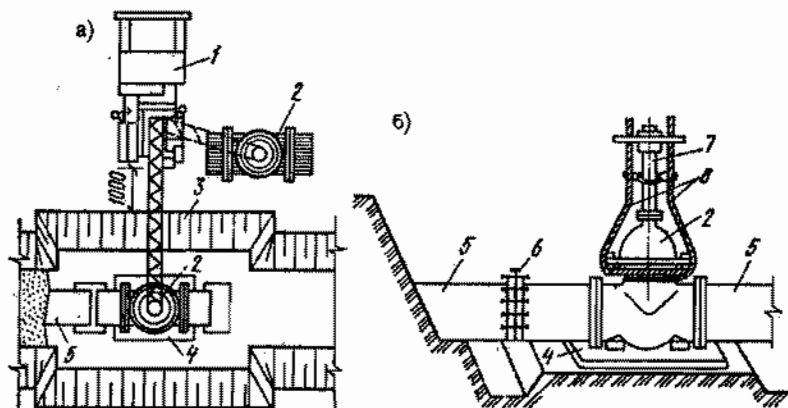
Монтаж узла задвижки: 1 - кран; 2 - узел задвижки; 3 - котлован; 4 - плита основания; 5 - трубопровод; 6 - центратор; 7 - шпindelь; 8 - ветви стропы
